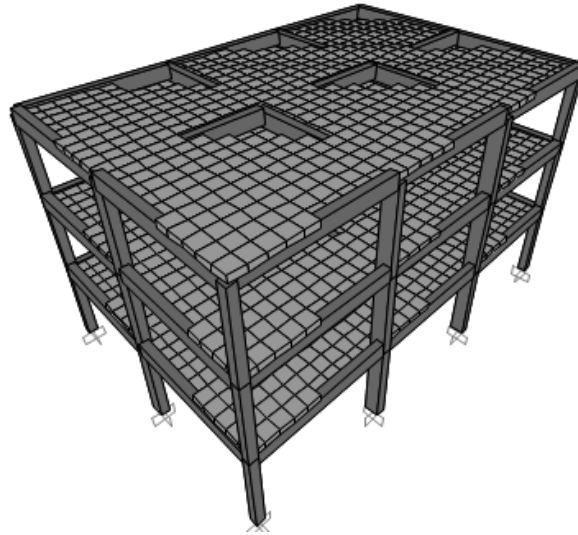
Representação da estrutura de betão armado estudada em perspetiva
